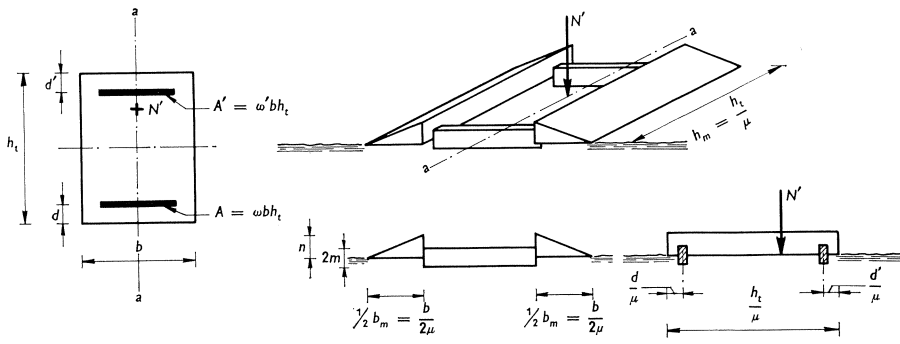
Model voor een rechthoekige doorsnede van gewapend beton.
